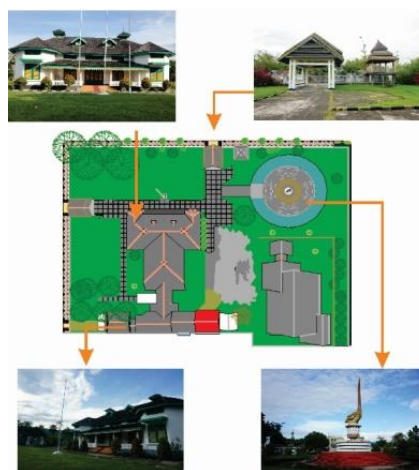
Denah dan suasana ruang dalam Museum Batara Guru Lagaligo
